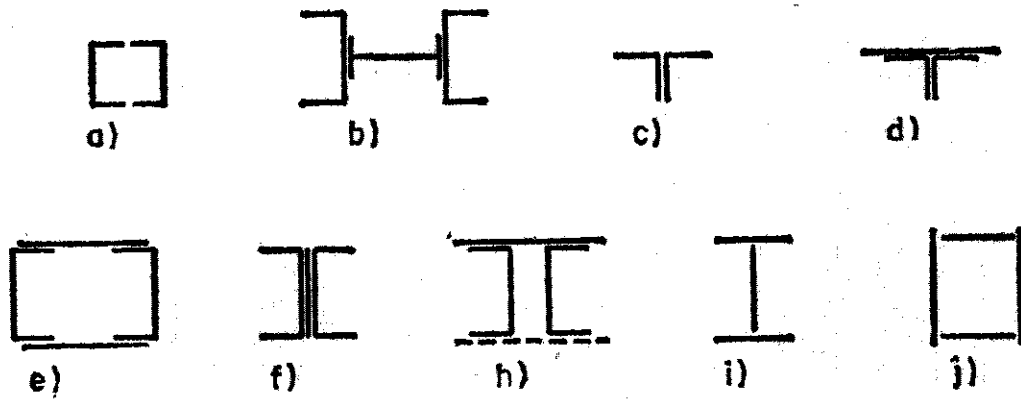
Ejemplos de piezas simples construidas por perfiles y/o chapas yuxtapuestas
